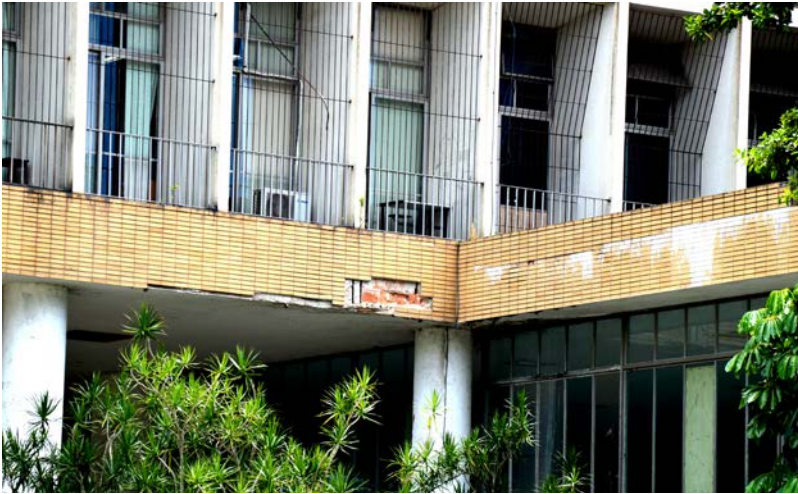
Deslocamento dos revestimentos e exposição da alvenaria na fachada sudeste do bloco A do edifício JMM.
